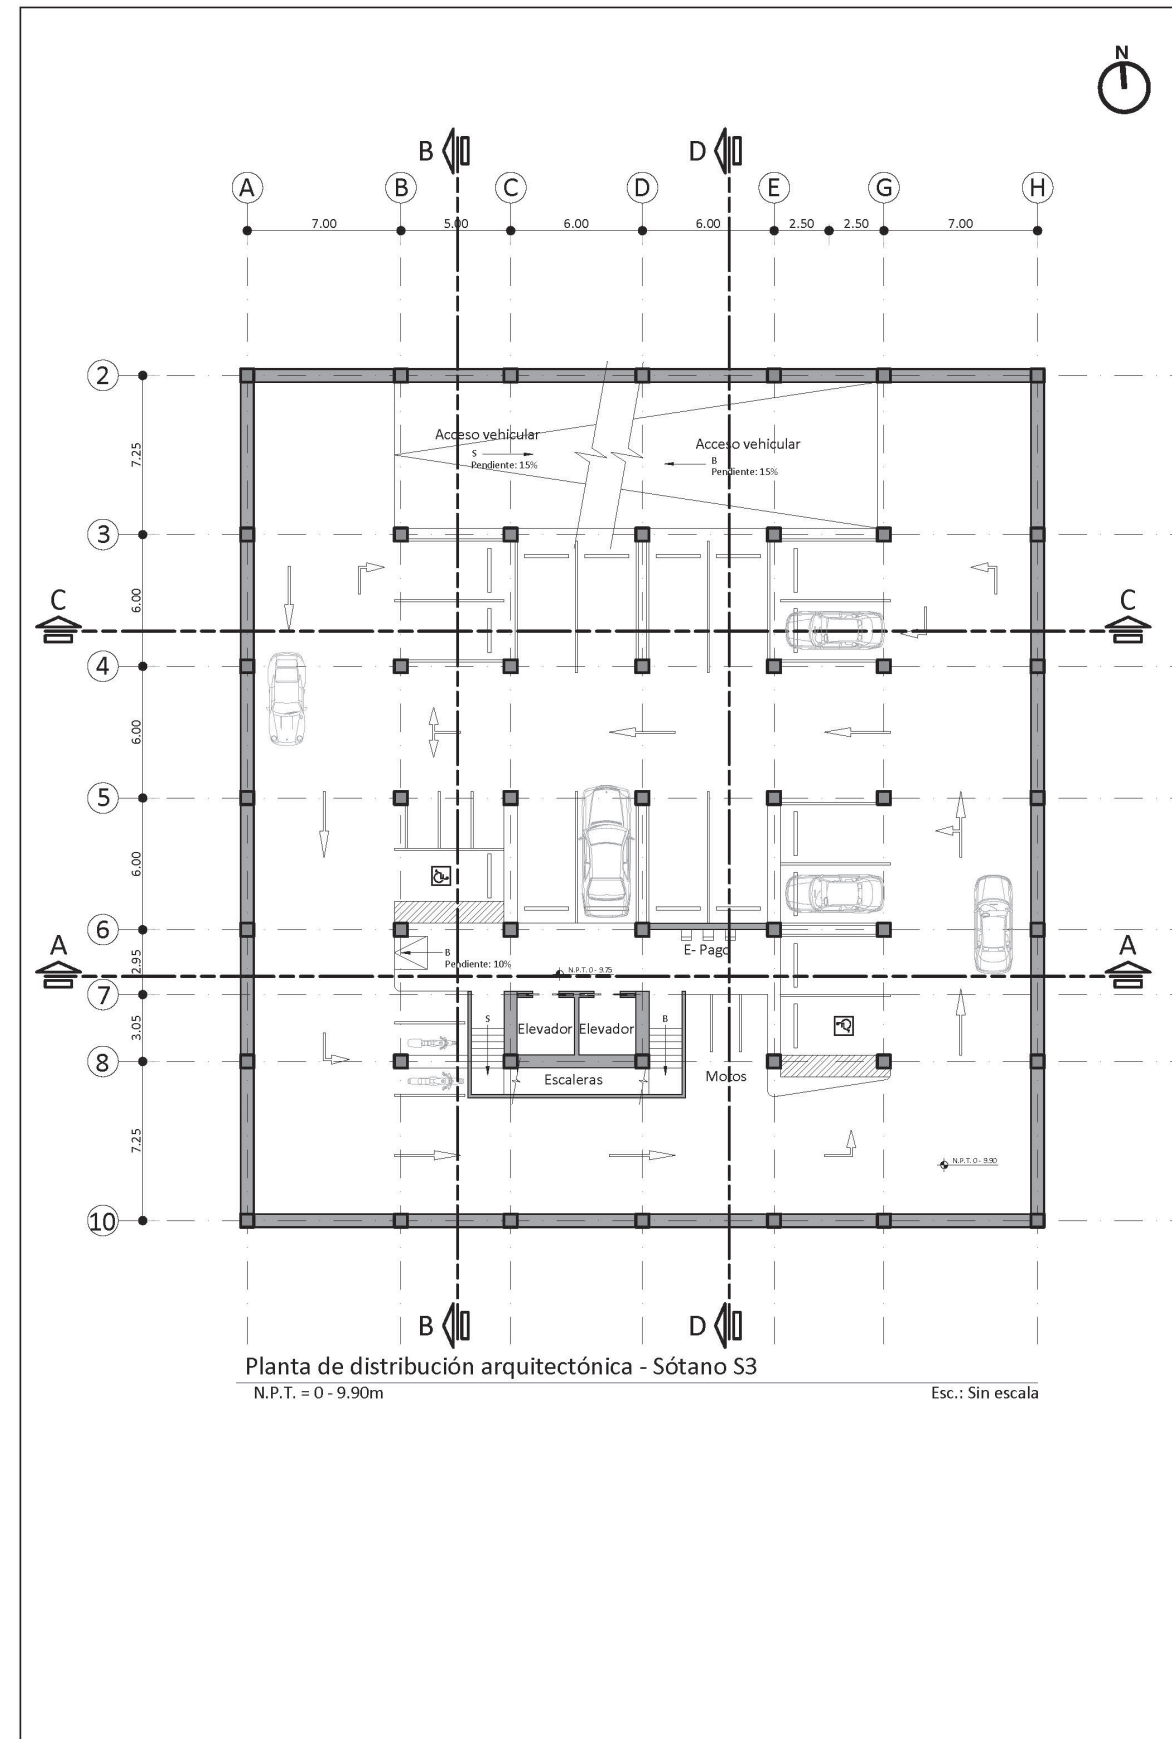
Planta de distribución arquitectónica de sótano 3. Fuente: Propia.
